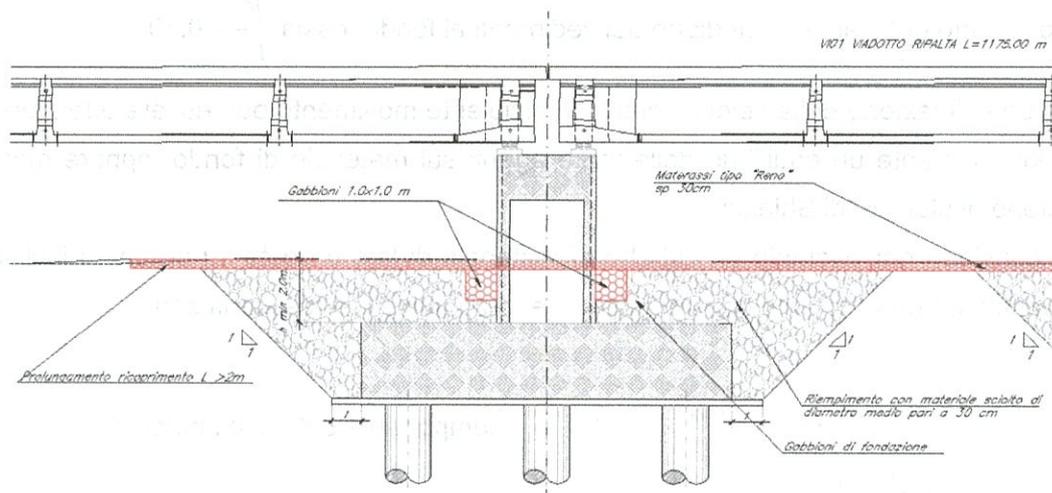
Protezioni al piede delle pile, sezione longitudinale del viadotto.
